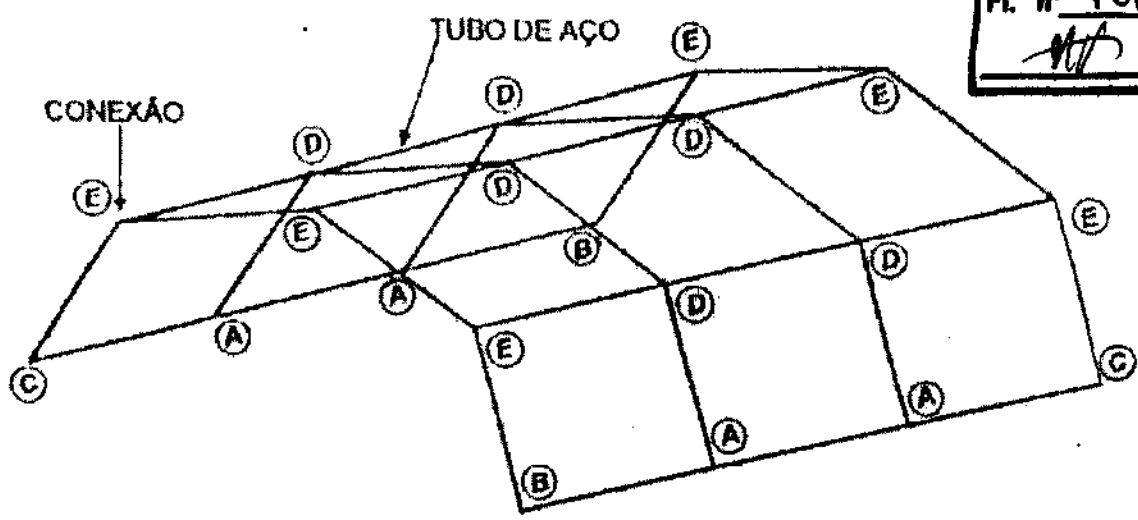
Estrutura metálica da barraca com localização das conexões - em perspectiva
